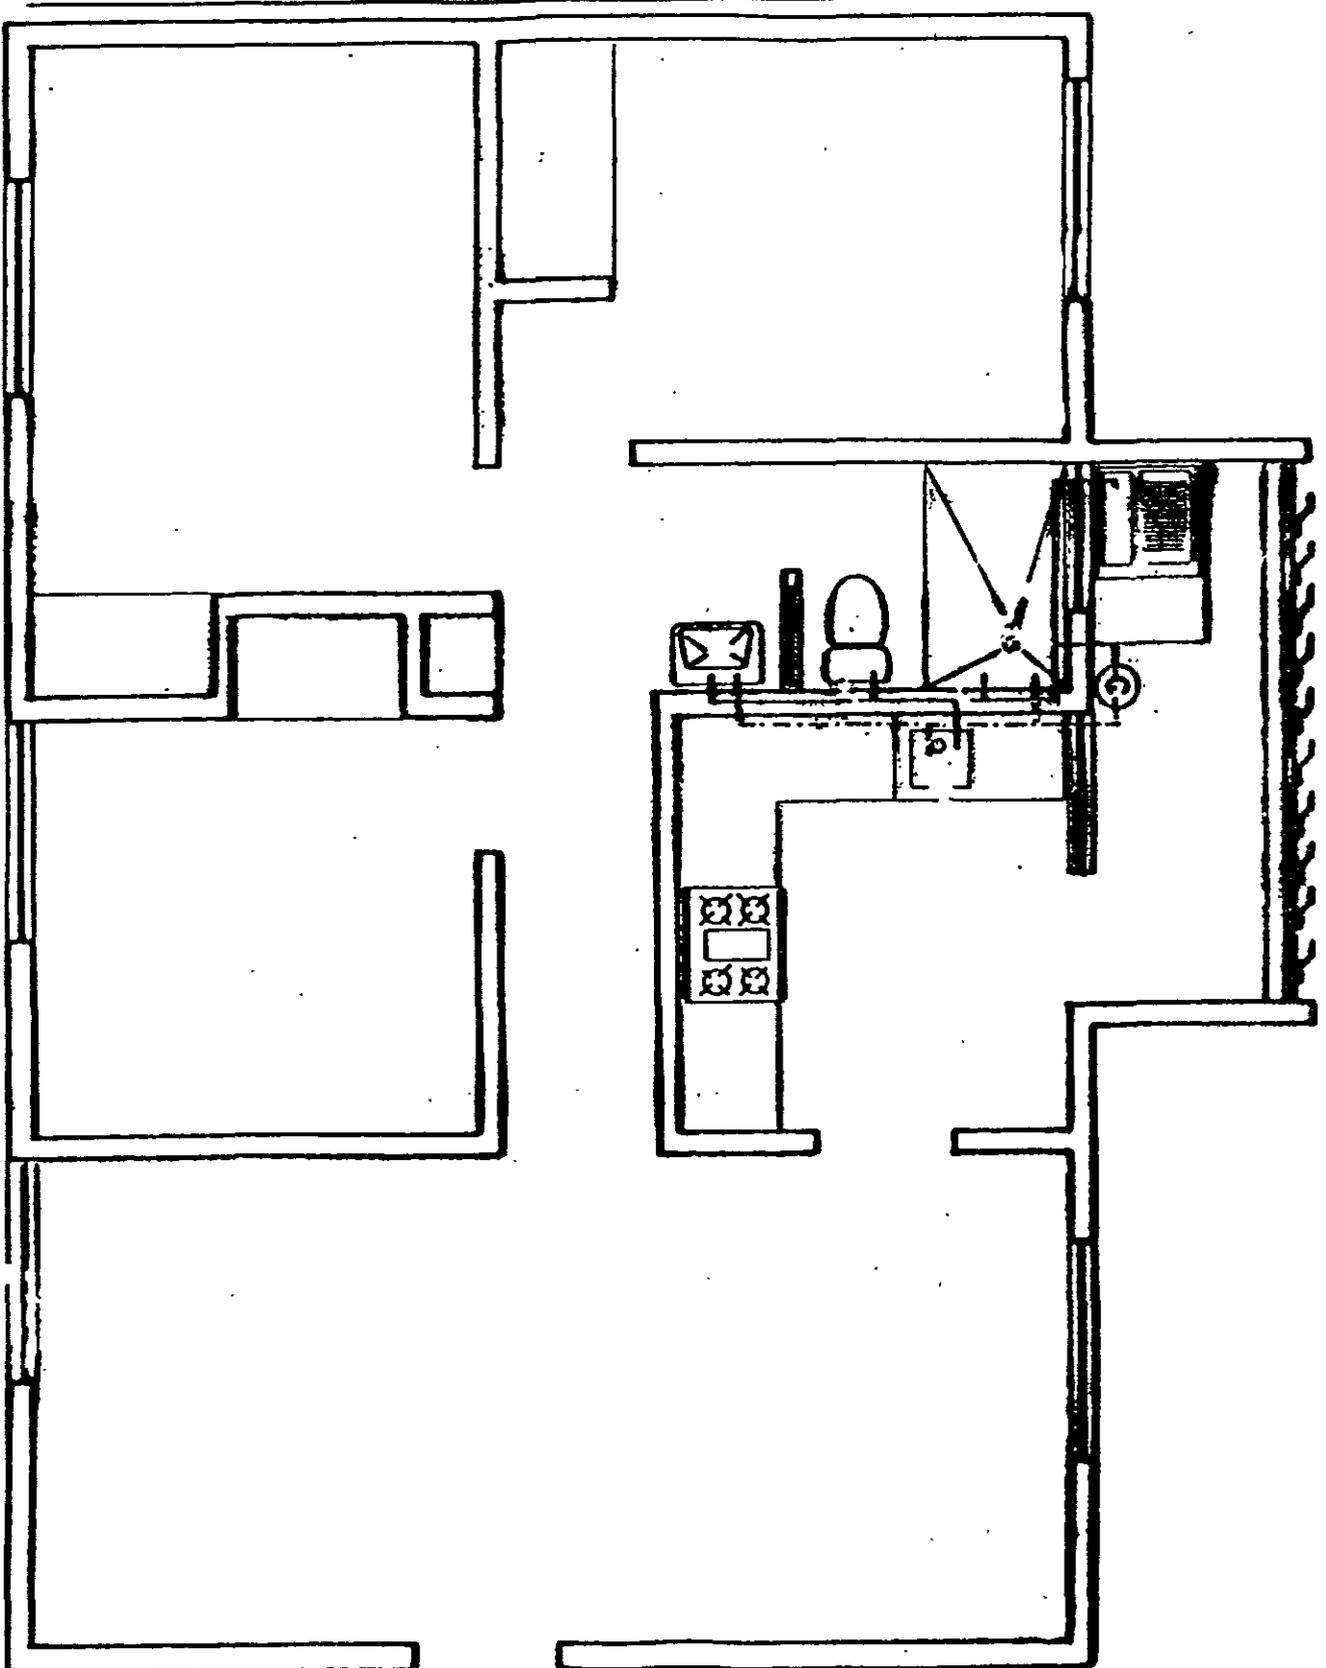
Planta tipo y corte de un edificio para uso habitacional.
